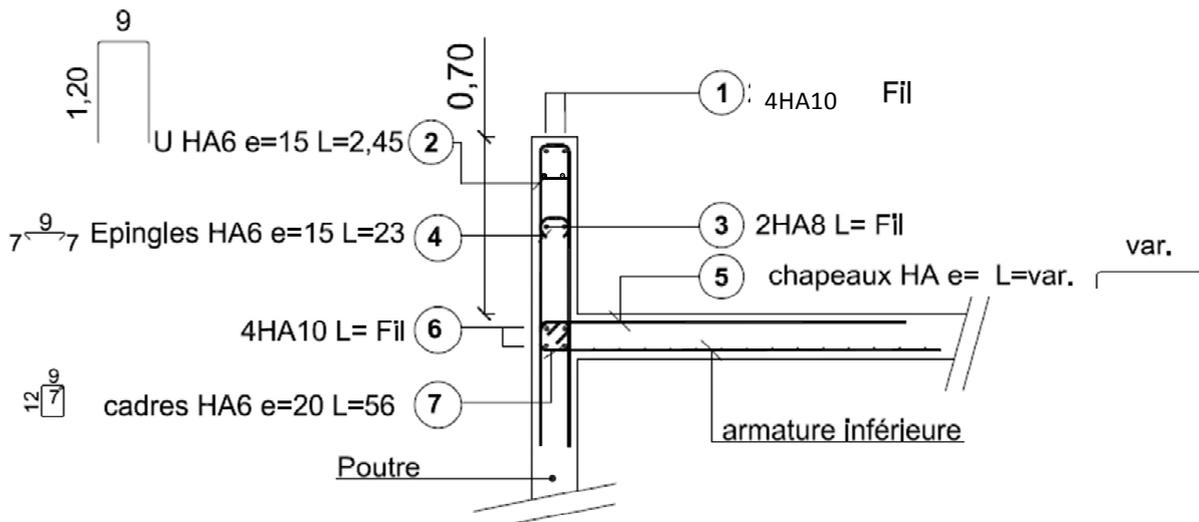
Schéma des armatures d'un solage sur poutre-longrine
